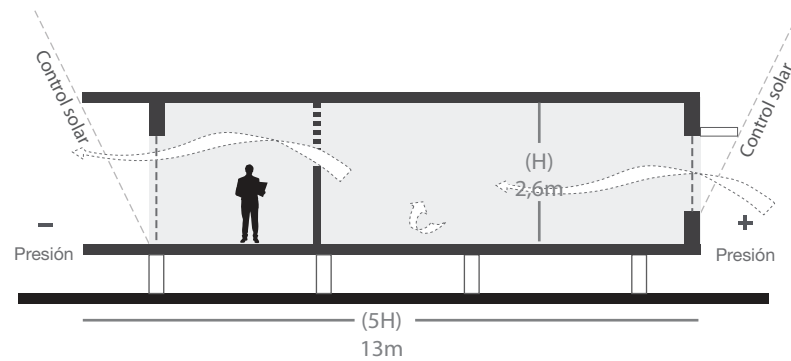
Configuración óptima en planta para el piso Premontano (elaborado por autores):
